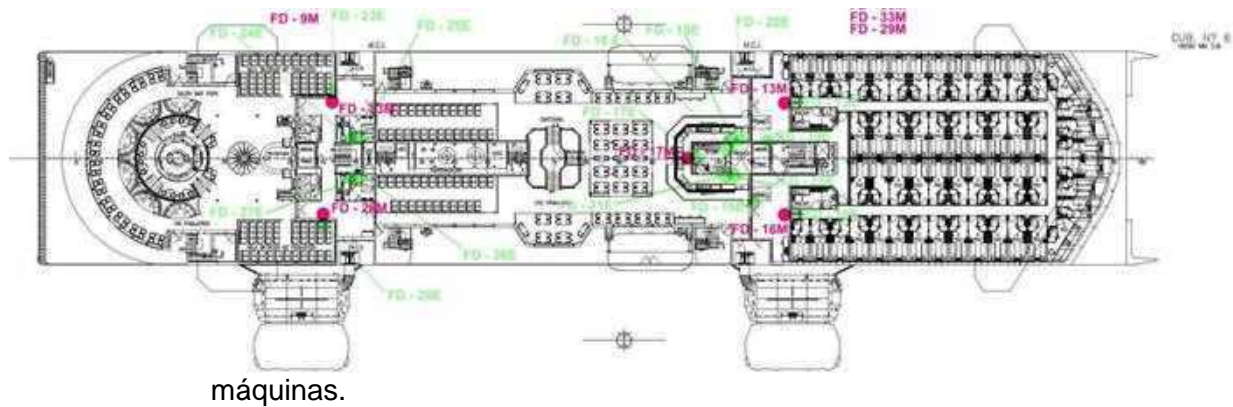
Plano localización “fire dampers” en la cubierta 6 del Volcán de Timanfaya.
